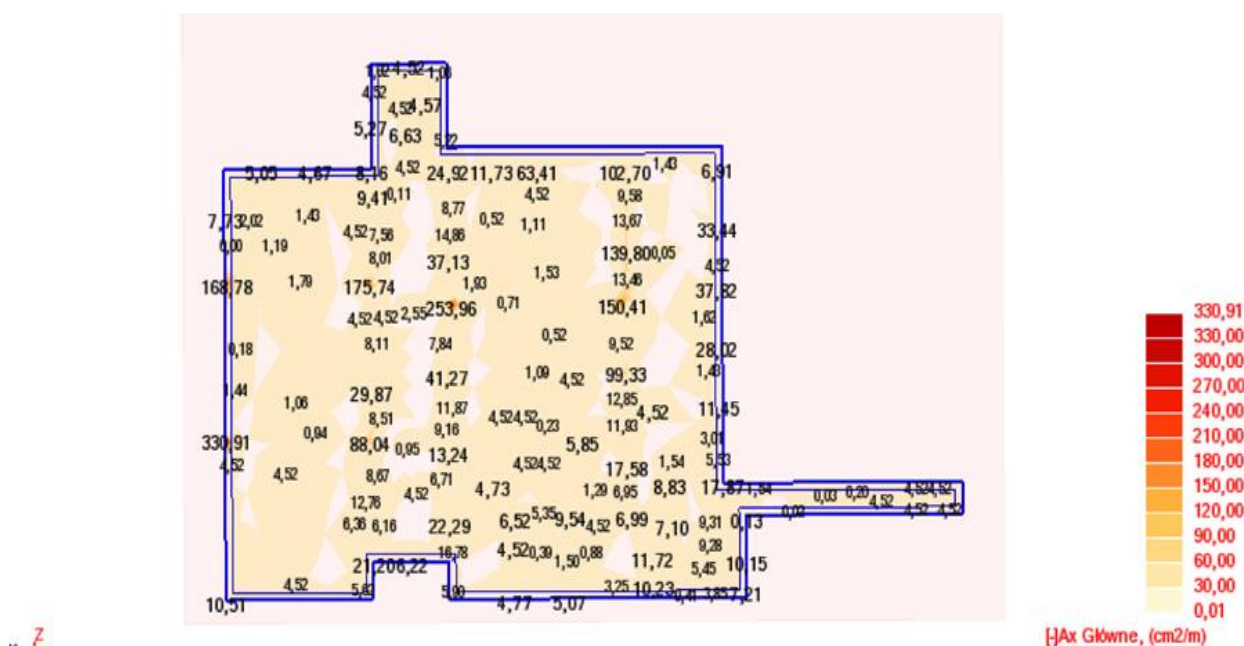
Płyta fundamentowa – widok od spodu.
